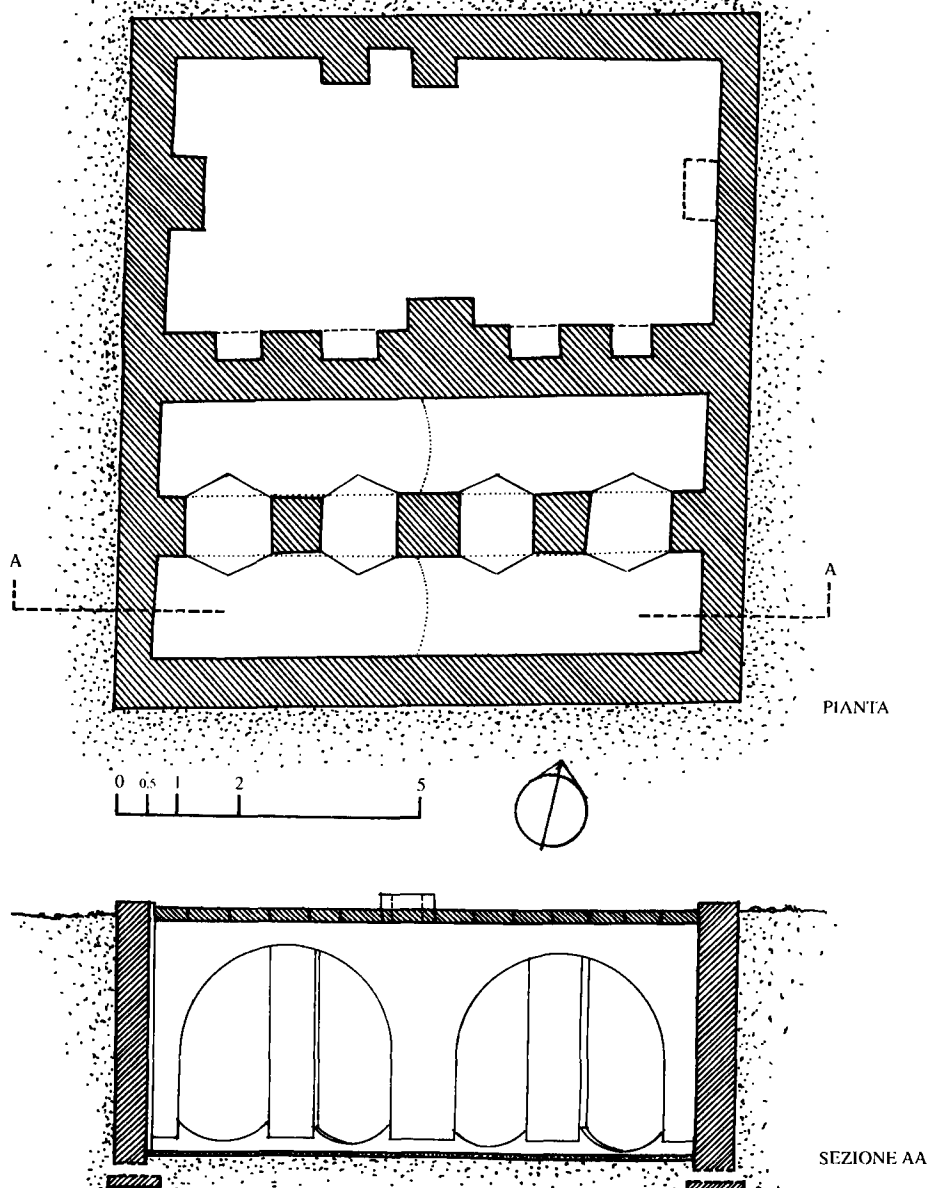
Le cisterne di Tavşan adası, pianta e sezione longitudinale
